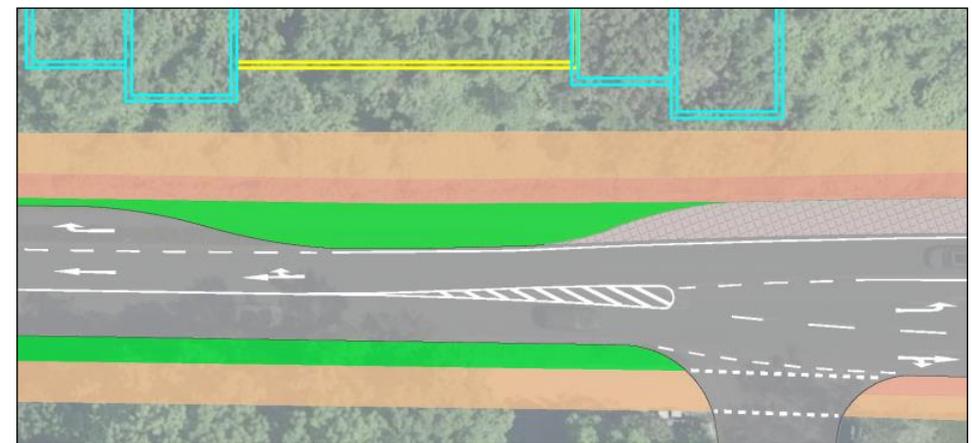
Lageplan Ausschnitt Geh- und Radweg
